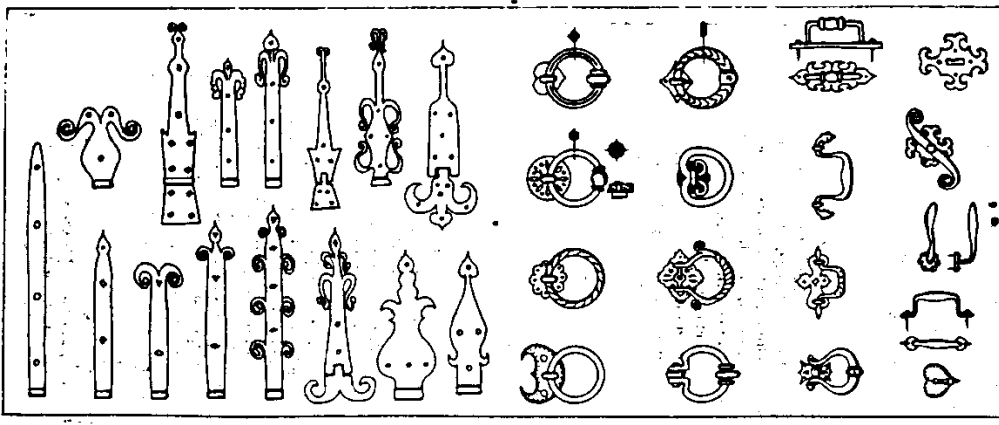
Кованые приборы дверей: а — жонки; б — ручки, ручки-стукала, личинки
